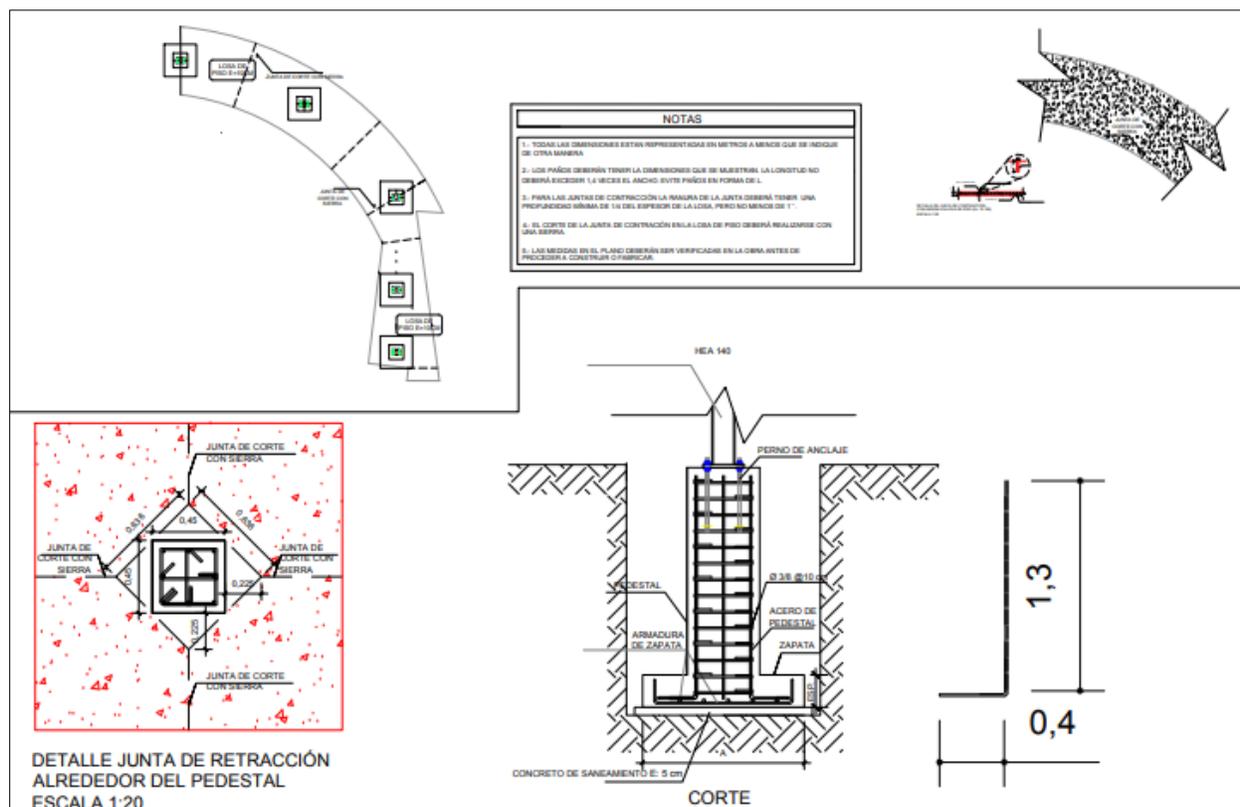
Detalle Estructural Junta de Contracciones, Zapatas y Pedestales. Adaptado de: *Detalles Estructurales Adecuaciones Funcionales Casona.
